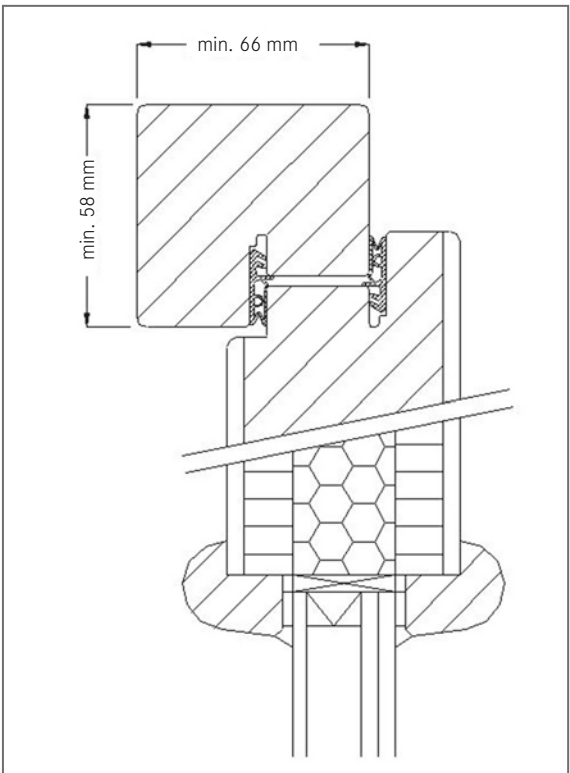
Einfachfalz mit Doppeldichtung [Quelle: TSH System GmbH]
